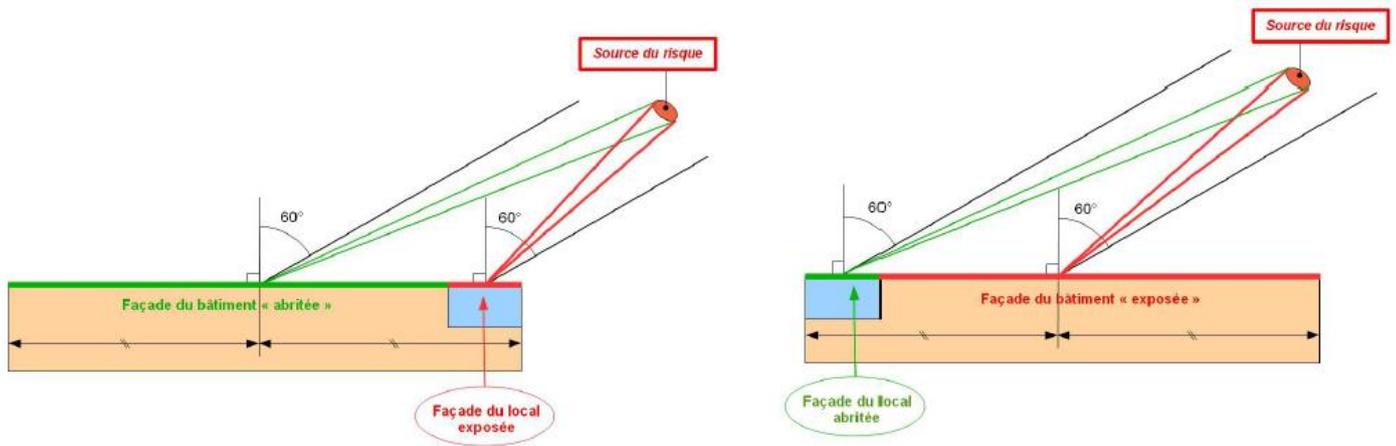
Exposition des façades à un site industriel en cas de bâtiment long
